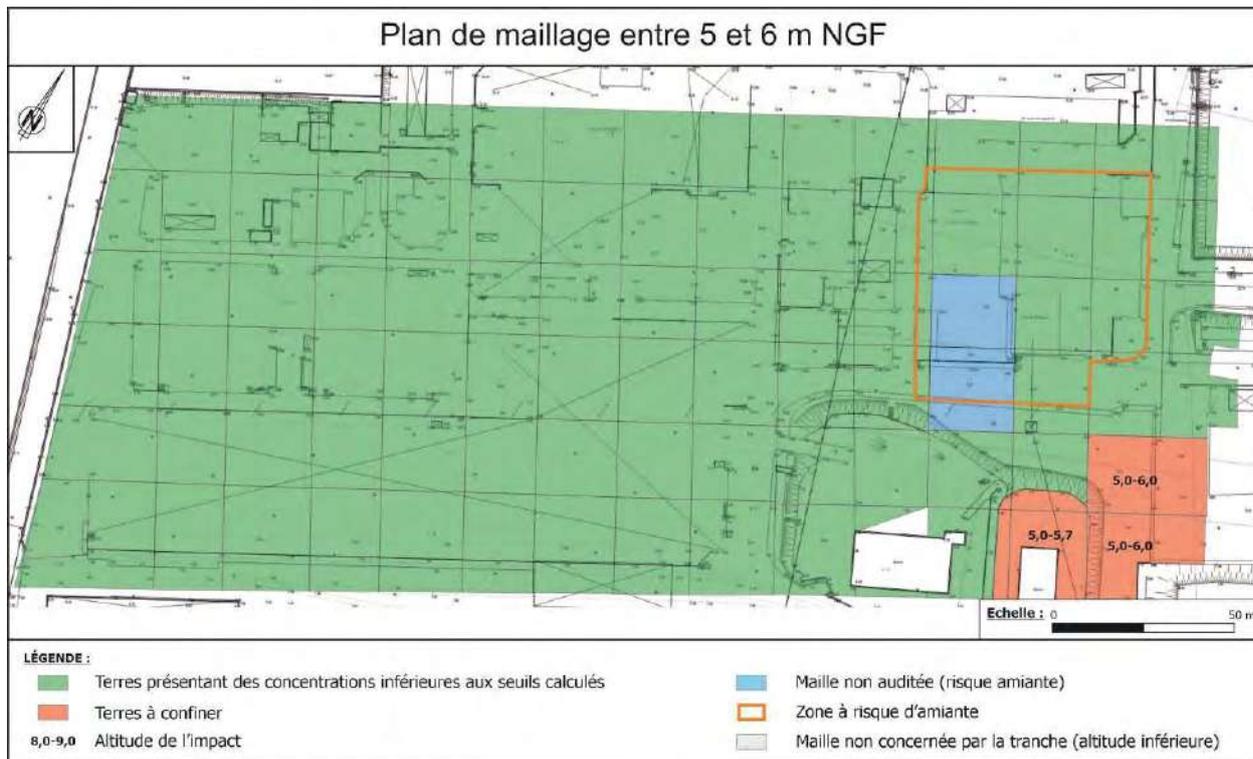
Plan de maillage entre 5 et 6 m NGF
